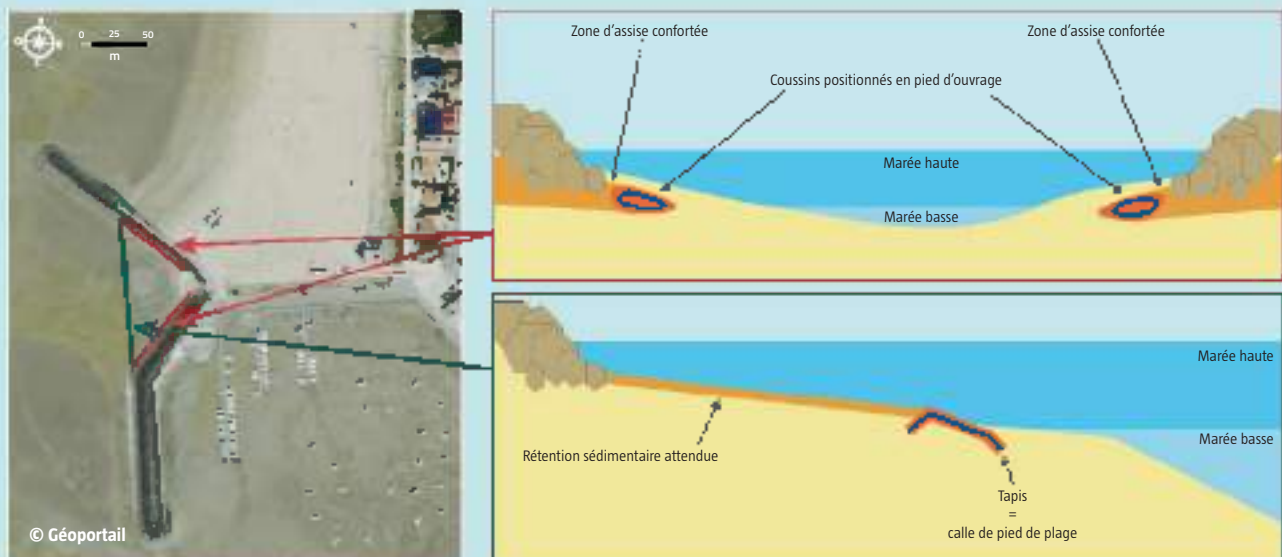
position des différents dispositifs mis en place sur le site de Châtelailon-Plage. En haut : coupe transversale de la zone du chantier et position du dispositif en pied d'ouvrage ; En bas : coupe dans le profil de la zone intertidale et position du dispositif en bas de plage.
